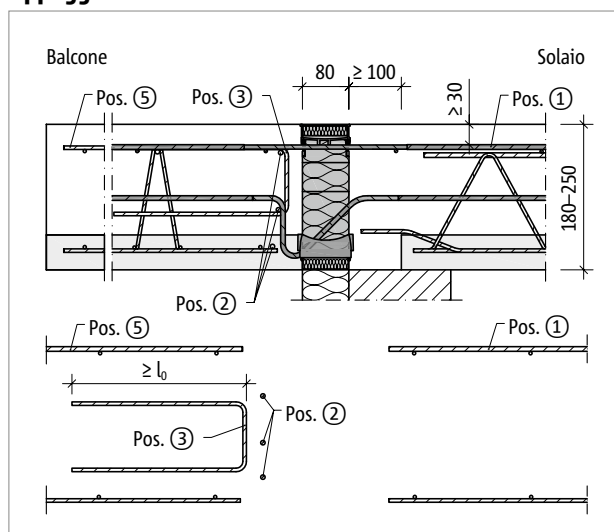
Schöck Isokorb® T tipo K-F: armatura in opera con spessore soletta del balcone $h = 180-250$ mm; variante con staffa a innesto
